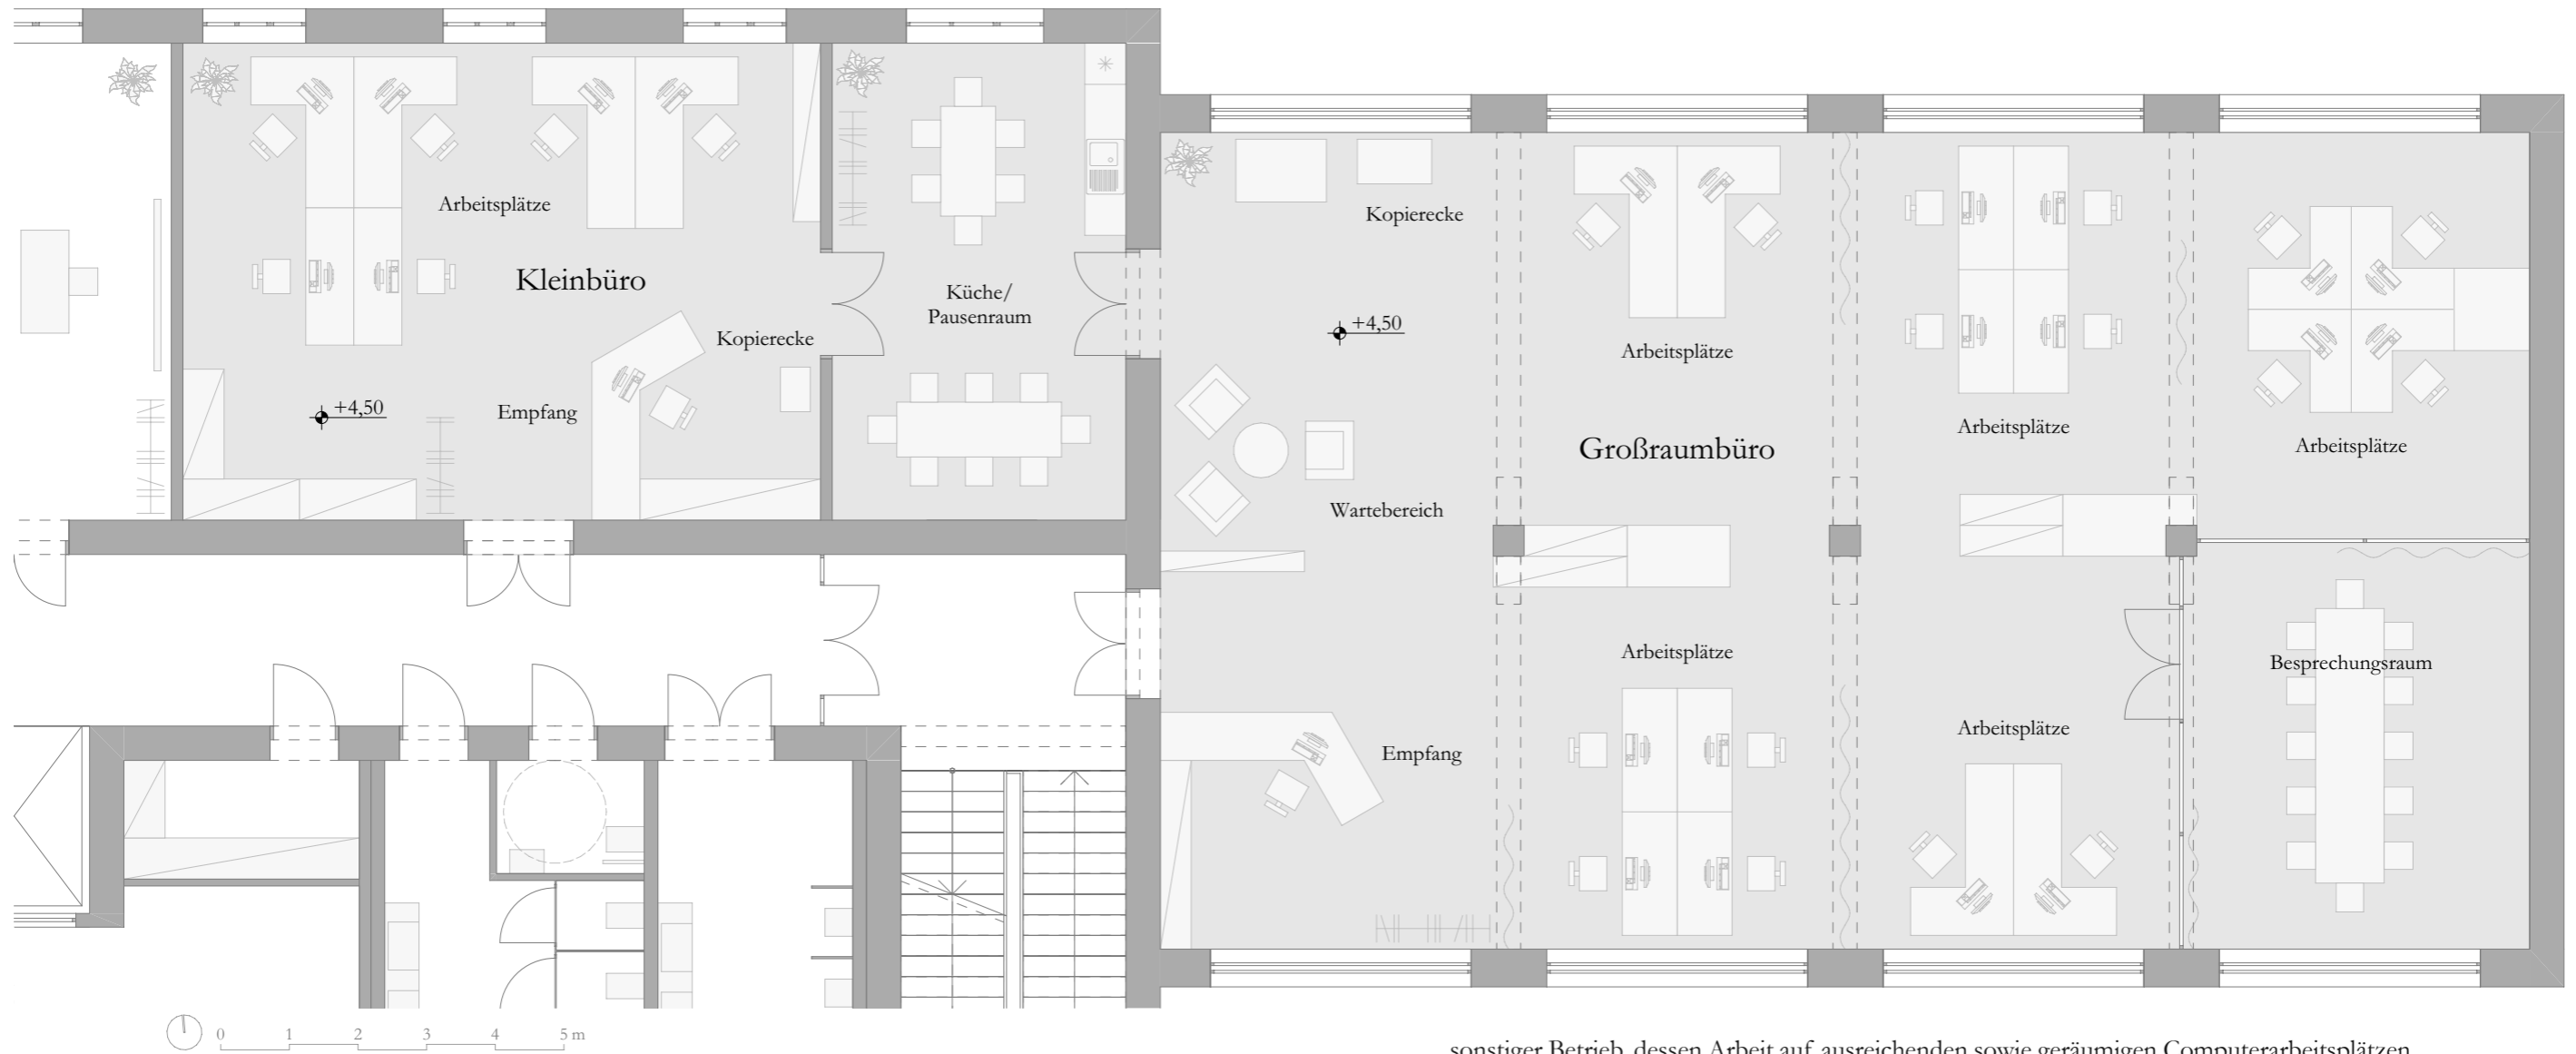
Grundriss Obergeschoss (Detail Büroräumlichkeiten) M 1:100
